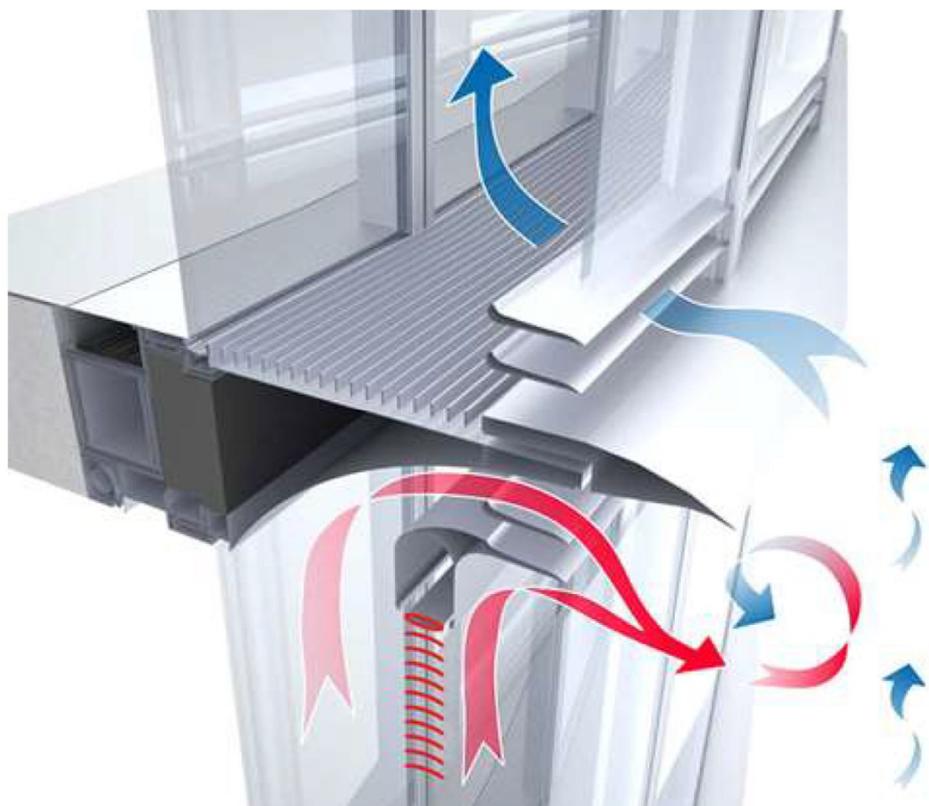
Вентиляция (поэтажная) двойного фасада «Double Skin»
